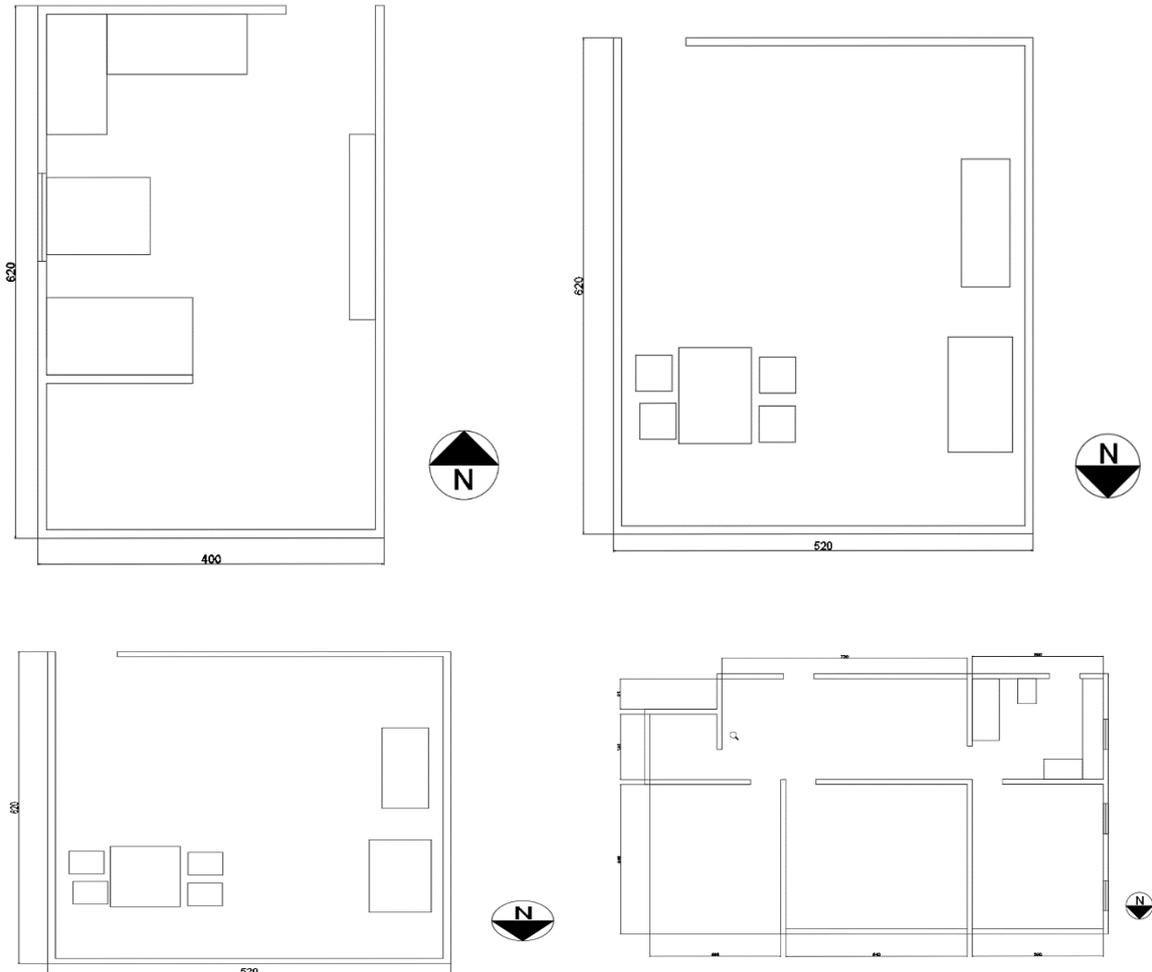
Plantas arquitectónicas de las viviendas N1, N2, N3 y N4 con norte. Elaboración propia
